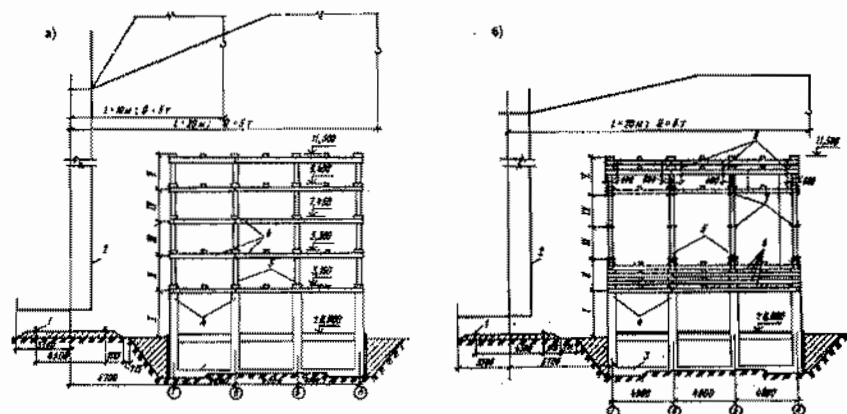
Монтаж типовой сборной железобетонной вентиляционной градирни: а - способом снизу вверх; б - то же, сверху вниз; 1 - рельсовый подкрановый путь; 2 - башенный кран (типа КБ-100) грузоподъемностью 5 т; 3 - водосборный бассейн; 4 - монолитные колонны; 5 - сборные колонны; 6 - ригели; 7 - опорные детали; 8 - временные хомуты
